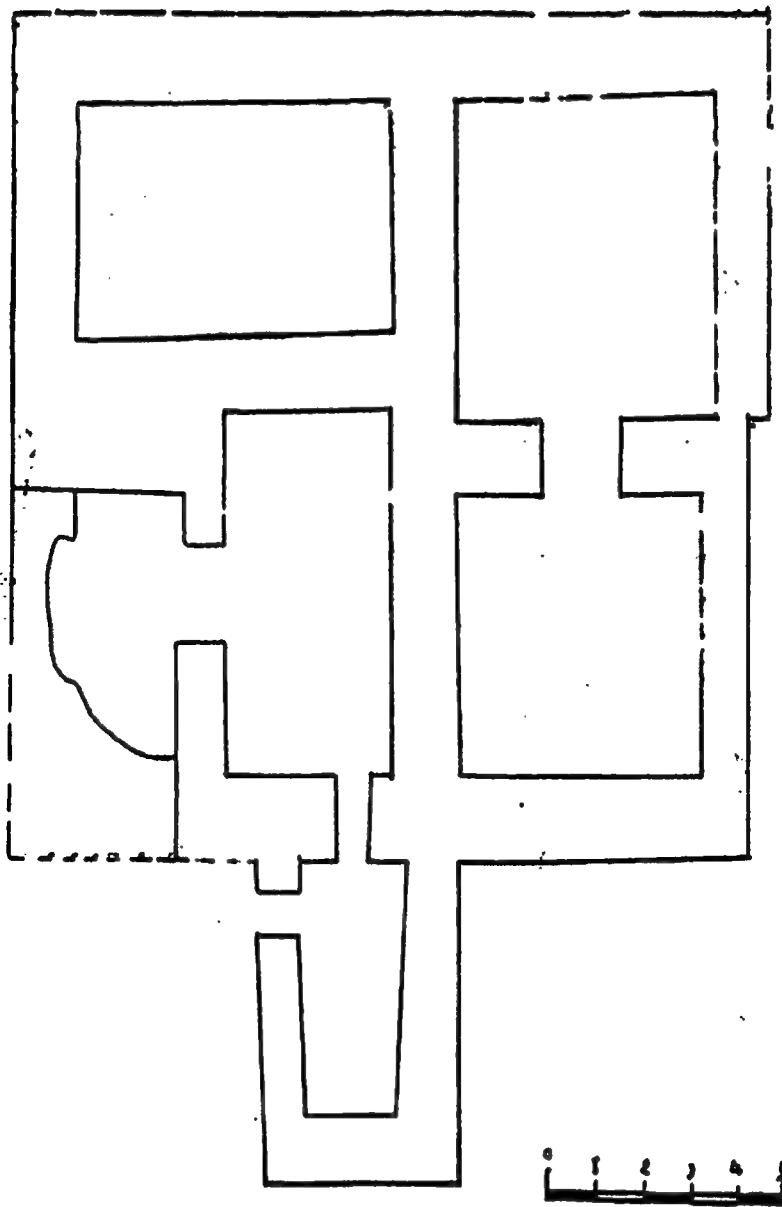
مسقط أفقى للتحصين الجنوبي بالقلعة حفائر موسم ١٩٨٩ (عمل الباحث).
